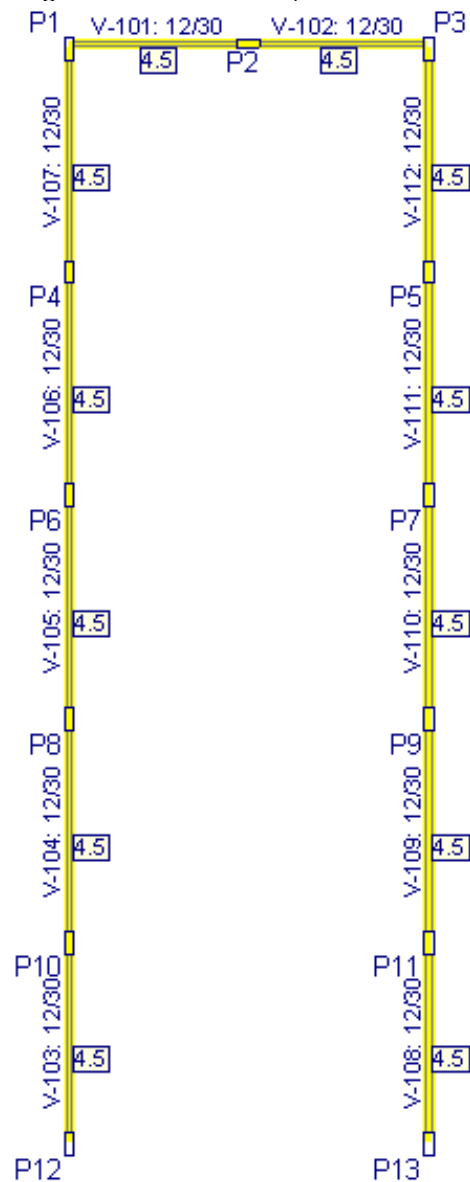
Planta Baixa Pavtº Tipo – EPP- 4
